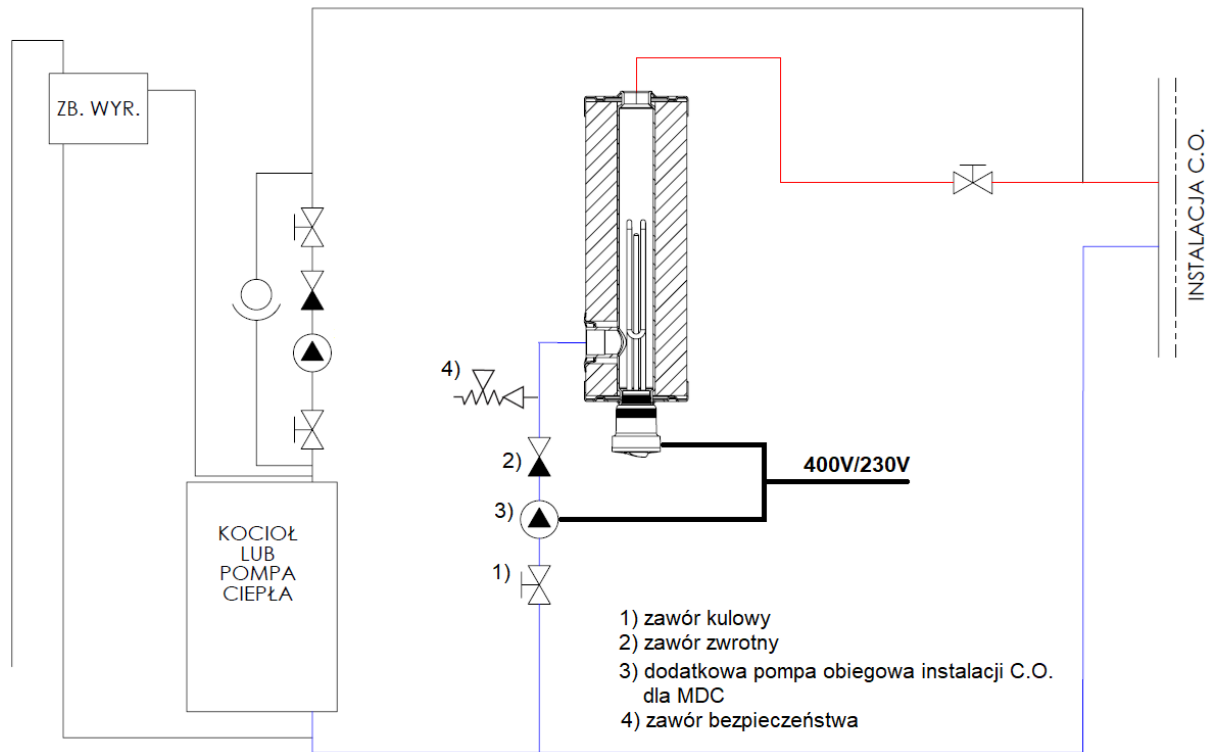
Przykładowy schemat montażu ogrzewacza typu MDC w instalacji C.O. systemu otwartego – pozioma pozycja instalacji.
